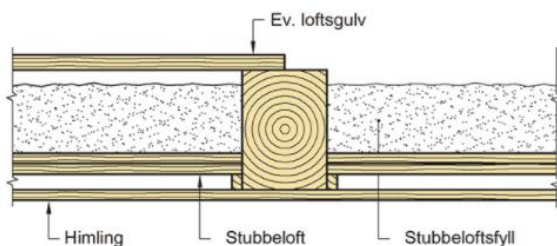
Konstruksjon utført i lett bindingsverk [27]
